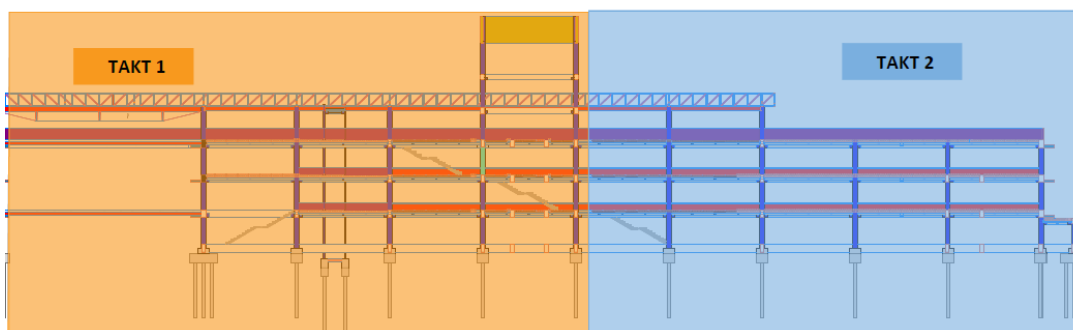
Planta Baixa *Takt* – Setor 2 (Prédio Principal)
